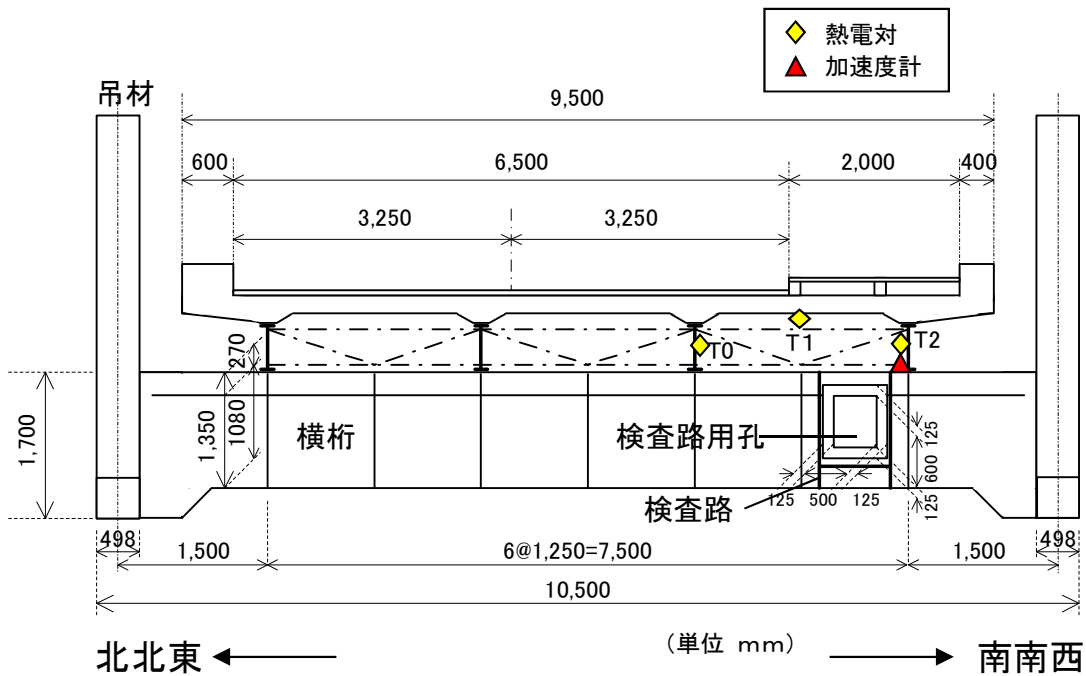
橋梁断面図 (C-C 断面) およびセンサー設置箇所
